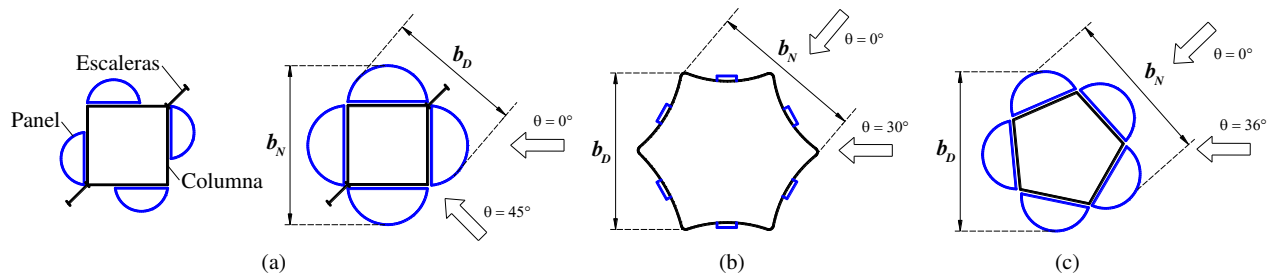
Secciones de antenas UHF: (a) tipo 1; (b) tipo 2; (c) tipo 3
